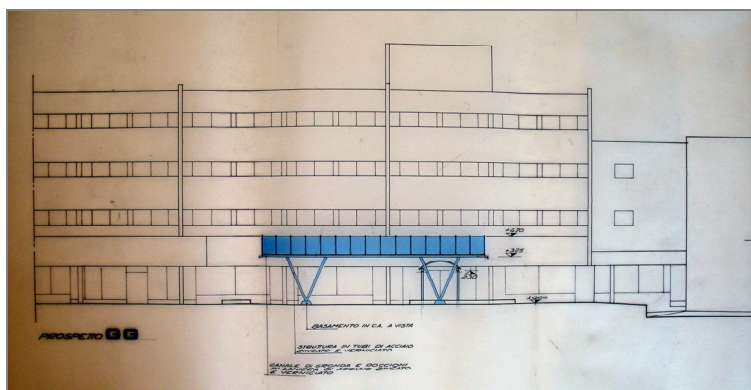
prospetto sud ovest corpo A (fonte CSAC – stralcio tav. 2, archivio n. 400-1)
